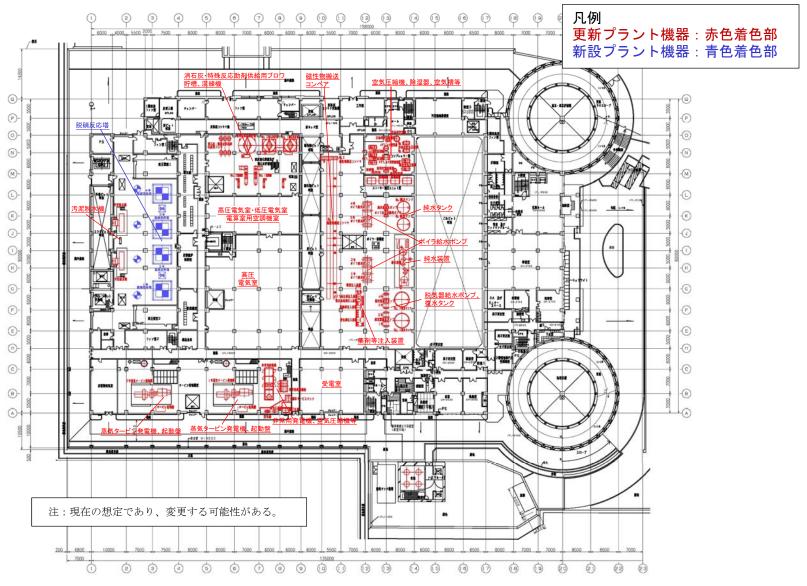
(2) 設備機器の更新箇所(2階平面図)
